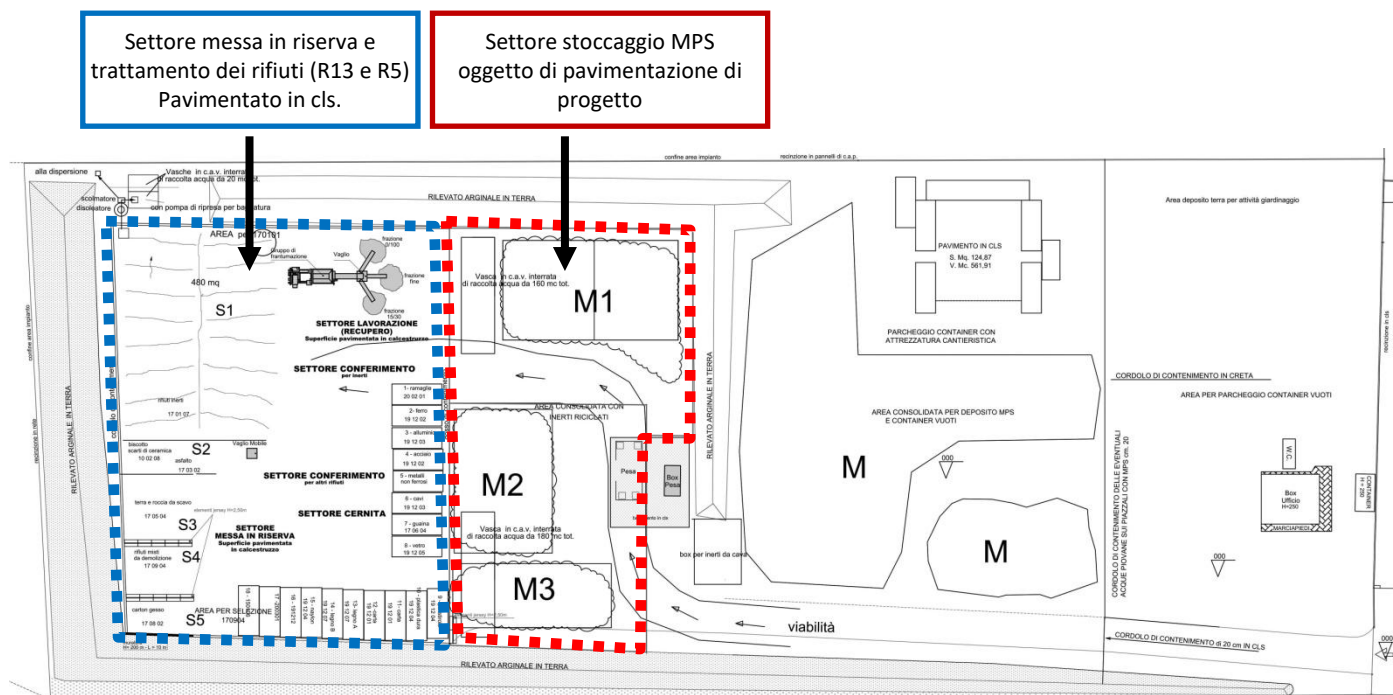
LAYOUT E MODIFICHE DI PROGETTO.
